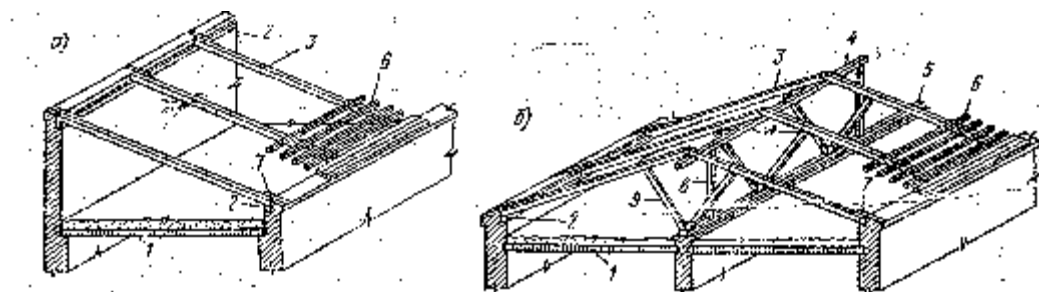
Общий вид наслонных деревянных стропил: а - односкатных крыш; б – двускатных: 1-чердачное перекрытие; 2-мауэрлат; 3-стропильная нога; 4-верхний прогон; 5-лежень; 6-обрешетка; 7-кобылка; 8-стойка; 9-подкос
